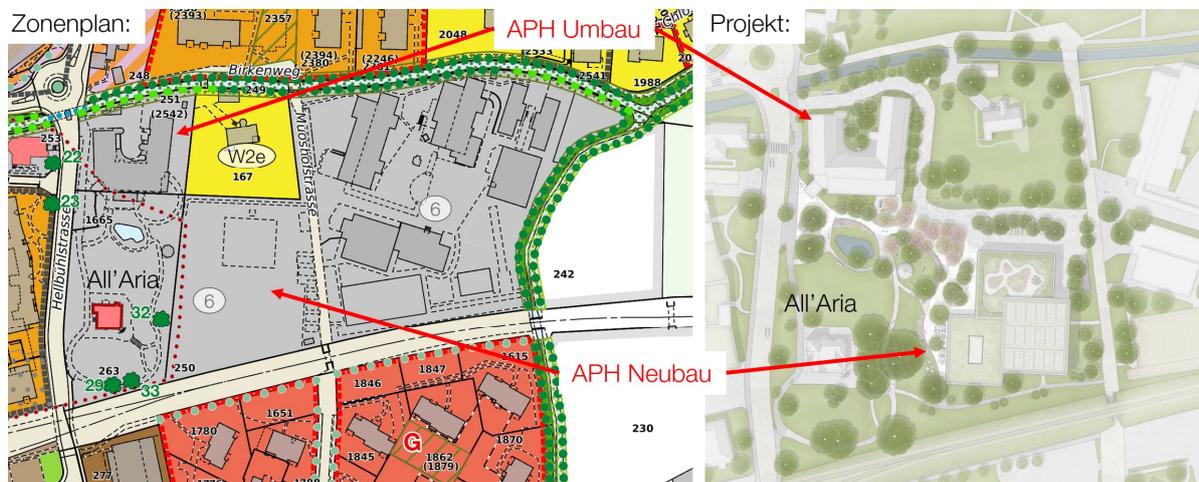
Ausschnitt Zonenplan; rechts Situationsplan Projekt (Quelle BPM AG)
